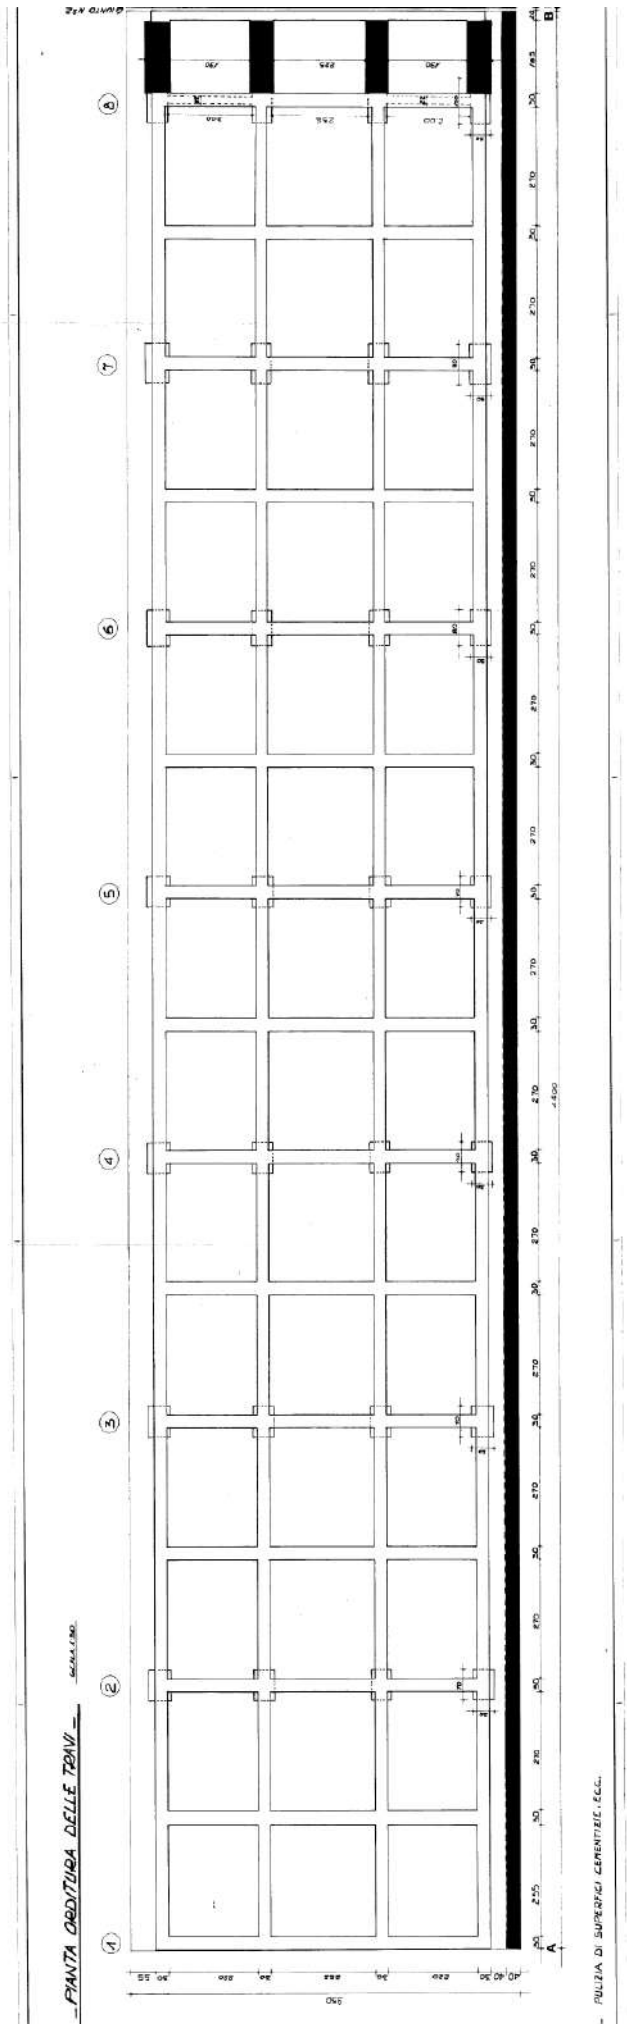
Stato di fatto: pianta orditura travi (e traccia pile) del ponte TENZA [riferimento al progetto originario file “n16.B”], con due carreggiate su tracciato rettilineo, sfalsate, con campate complanari. Planimetria carreggiate Nord e Sud, da demolire contemporaneamente.
